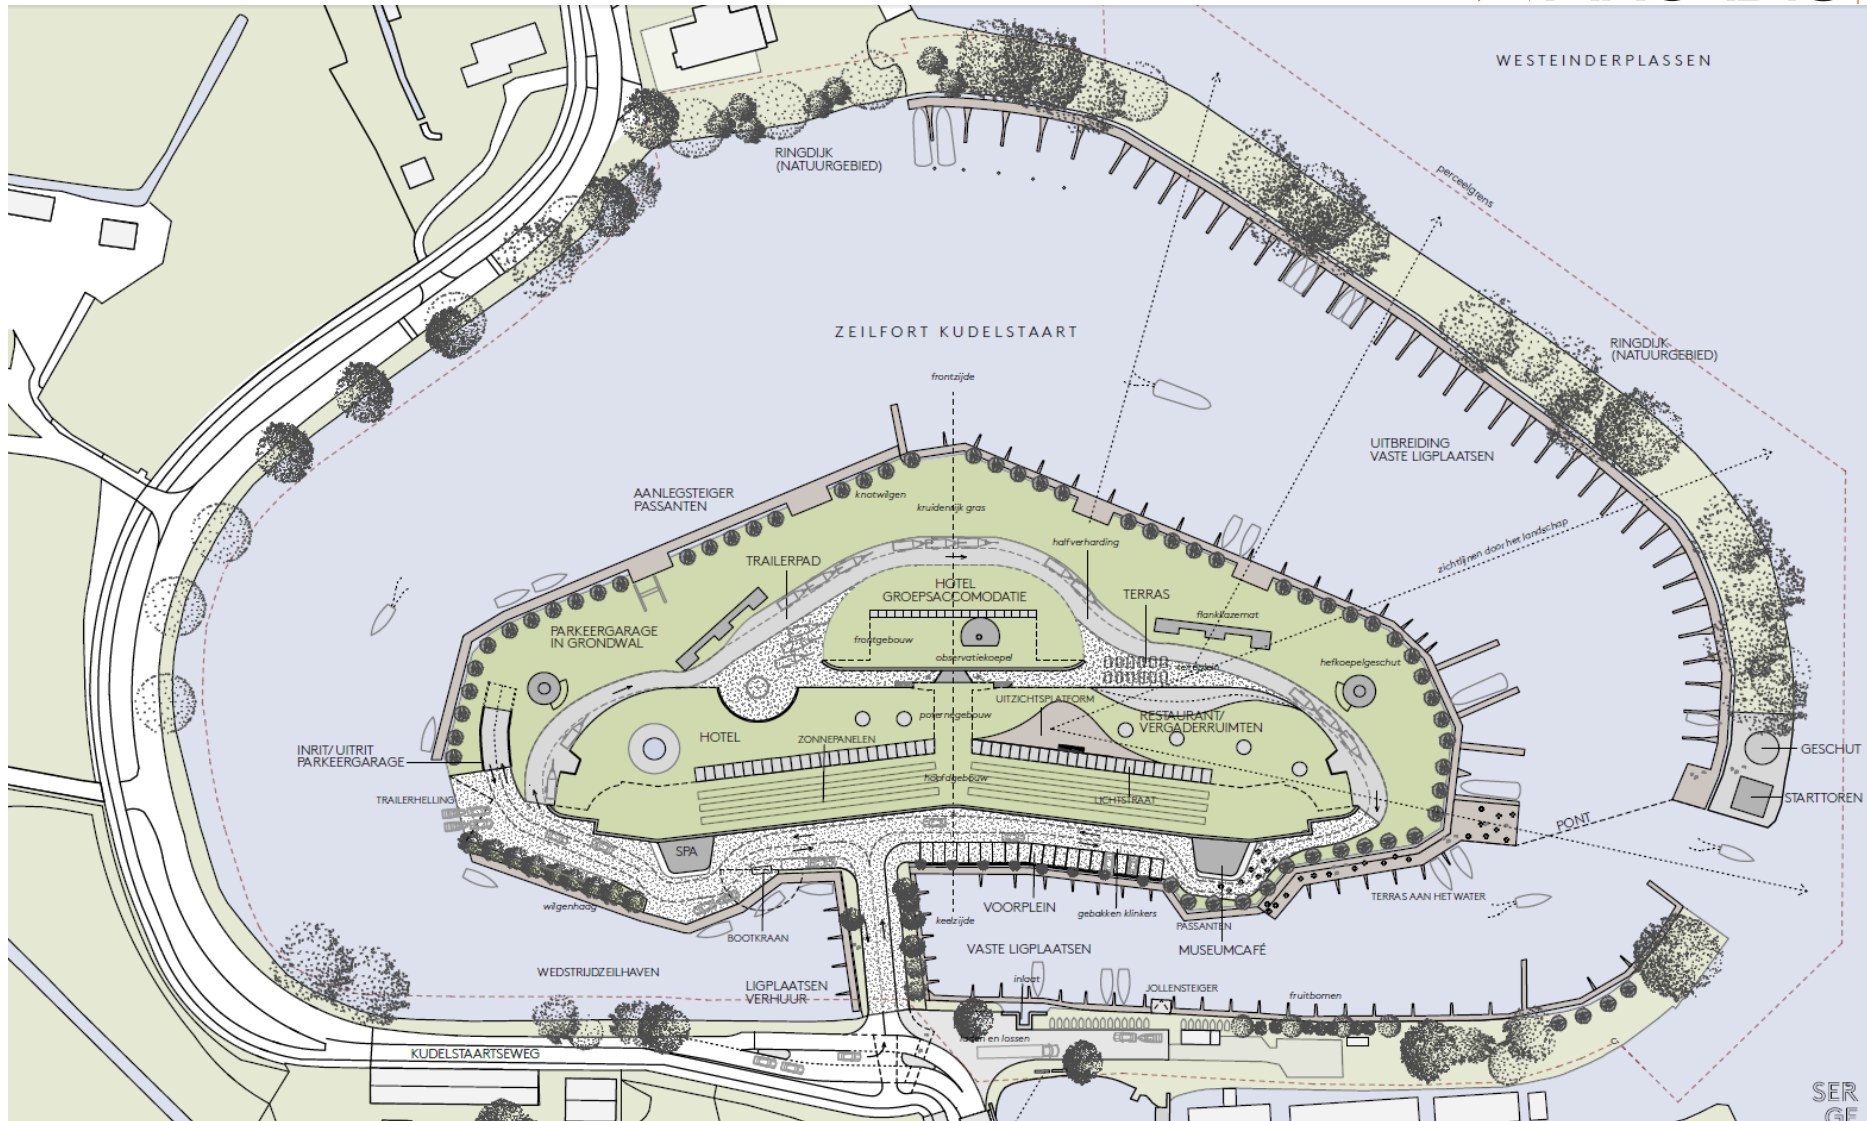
Overzicht van de te bouwen parkeergarage (bron: Masterplan).
